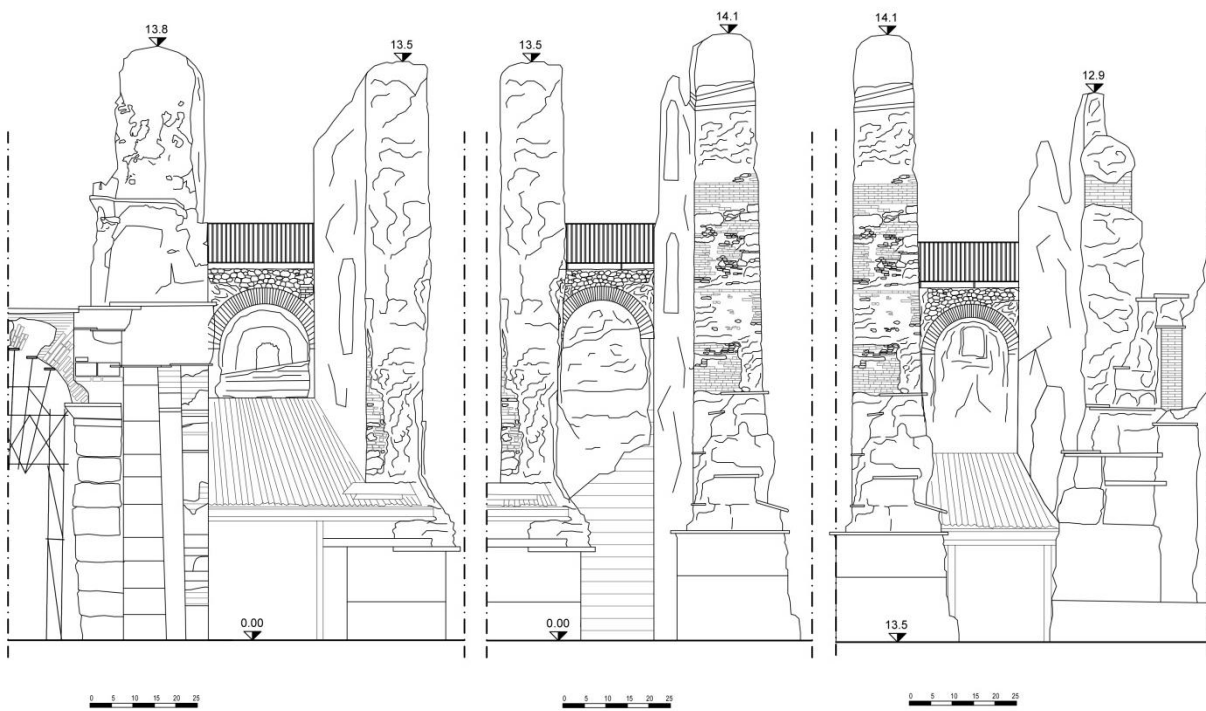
Prospetto laterale B1-B2, B2-B3, B3-B4
